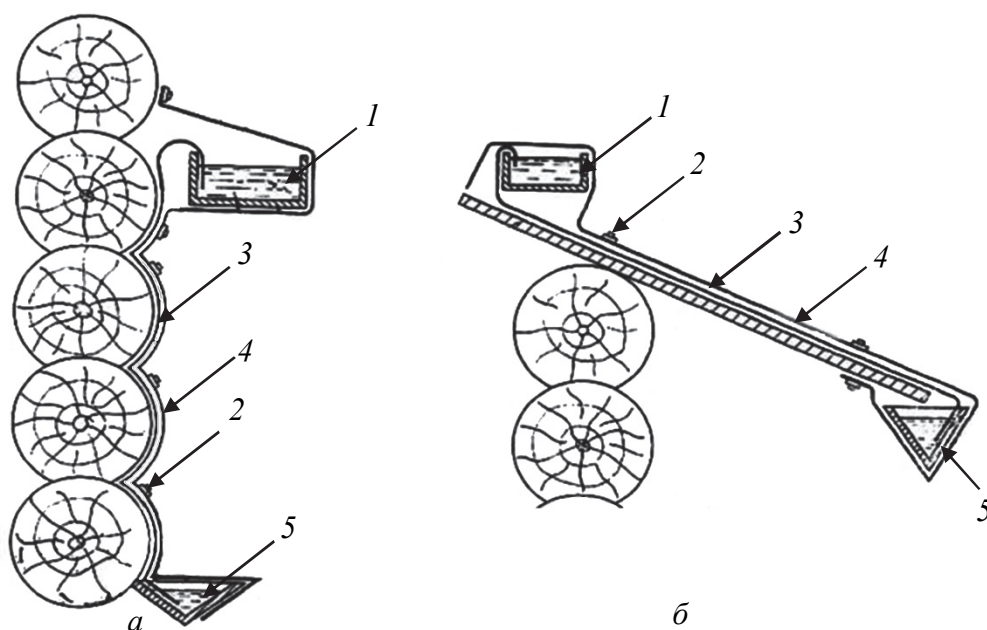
Схема панельного устройства для пропитки бревенчатой стены (а) и дощатой кровли (б):
